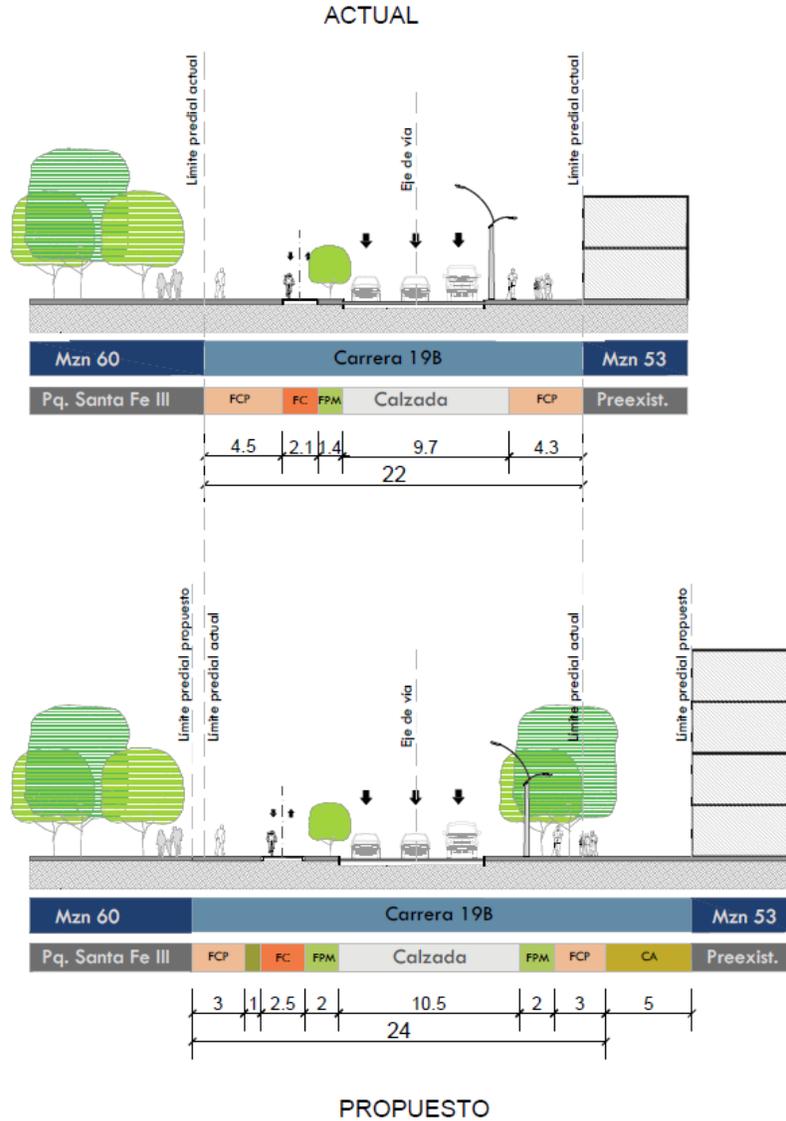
Perfil Carrera 19 B entre Calle 24 y Parque el Renacimiento
